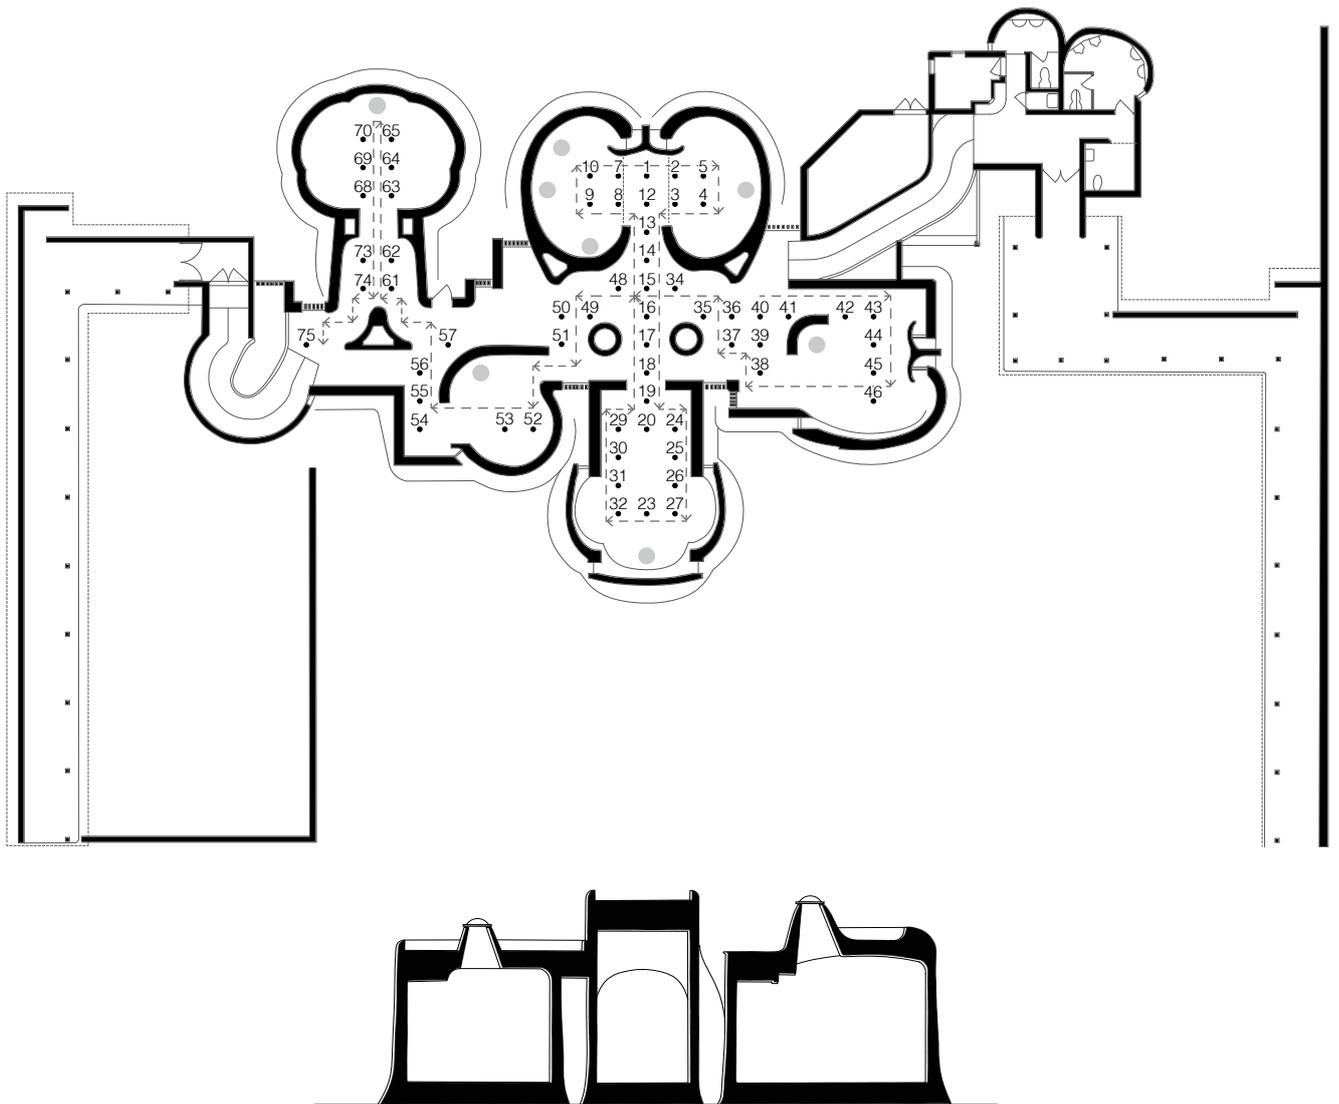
谷村美術館の平面図と撮影地点及び断面図
